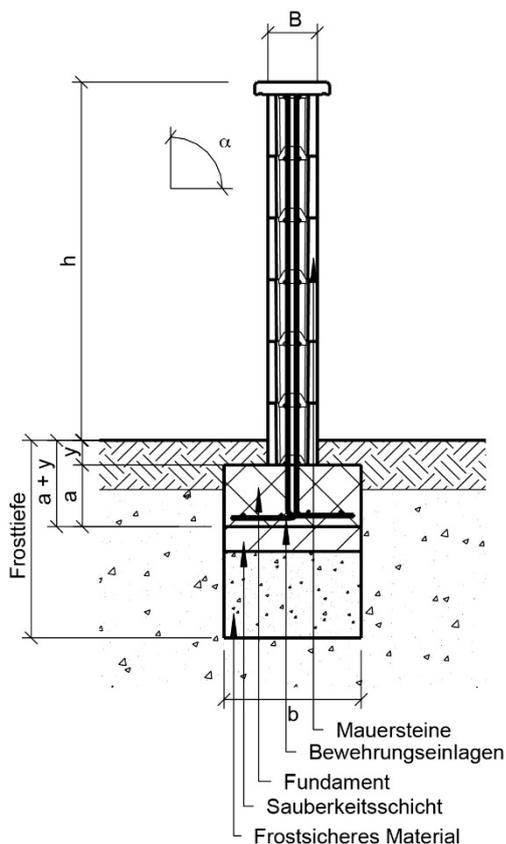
Maueraufbau freistehend, Windlast 1 kN/m²
